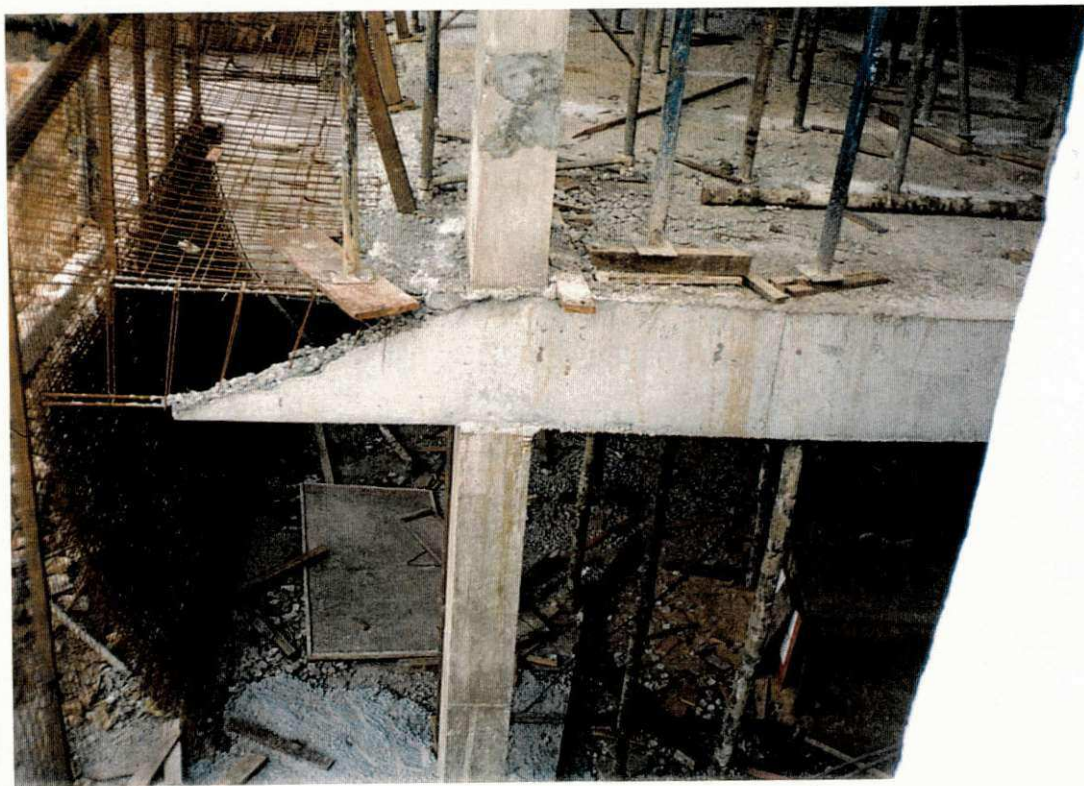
Junta de Concretagem em local de baixo esforço na estrutura
